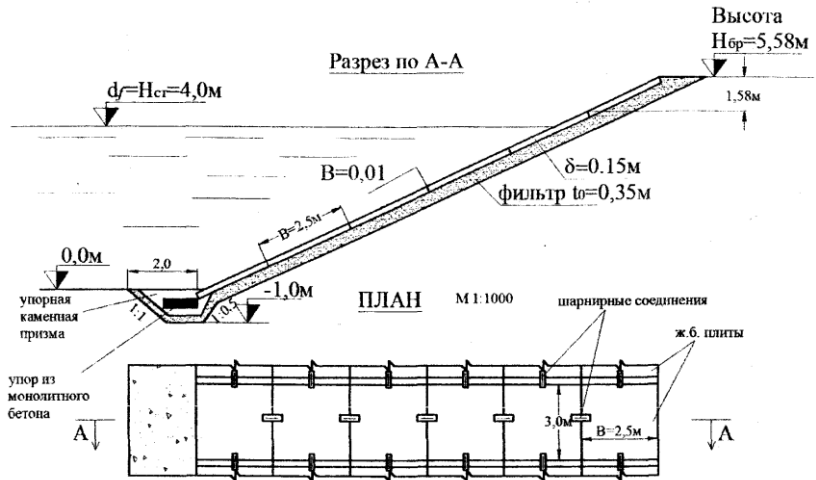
Общая схема укрепления бермы железобетонными плитами индустриального изготовления
